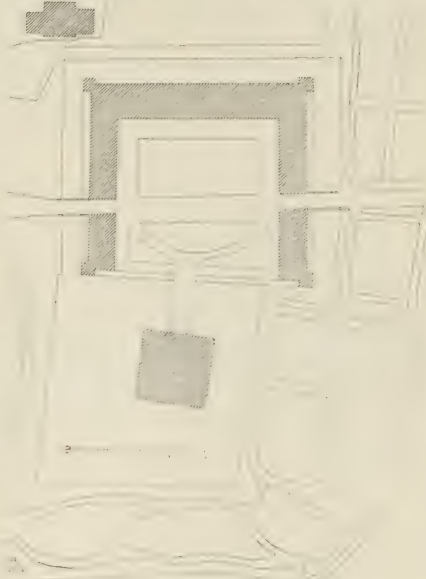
Kendenich. Grundriss der Burg.
